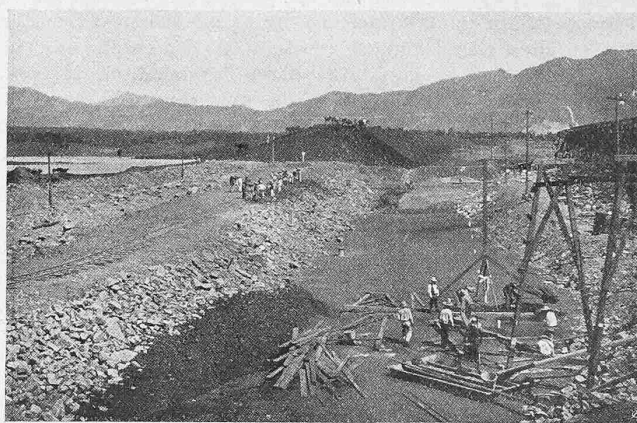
Links oberer, rechts unterer Fuss des Hauptdammes, dazwischen der Lehmkern, über dem ein neuer Einschwemmkanal errichtet wird (rechts). Im Hintergrund Aufführung des linken Flügeldammes mittels der «Scrapers».
